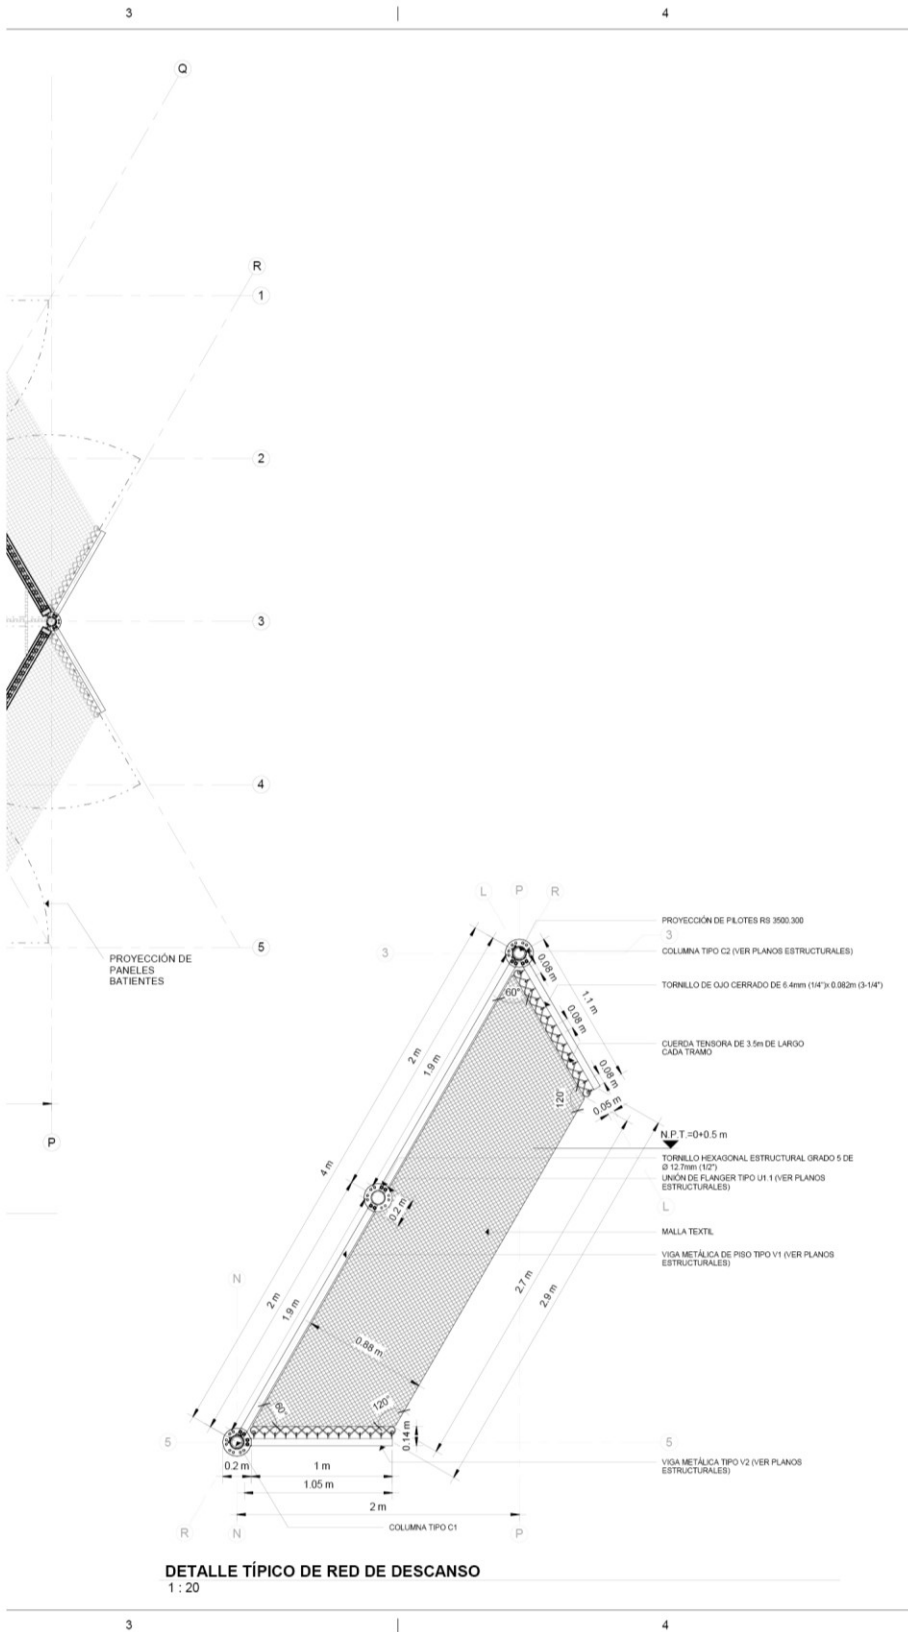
Lámina 04, planimetría de tipología B.<sup>313</sup>
